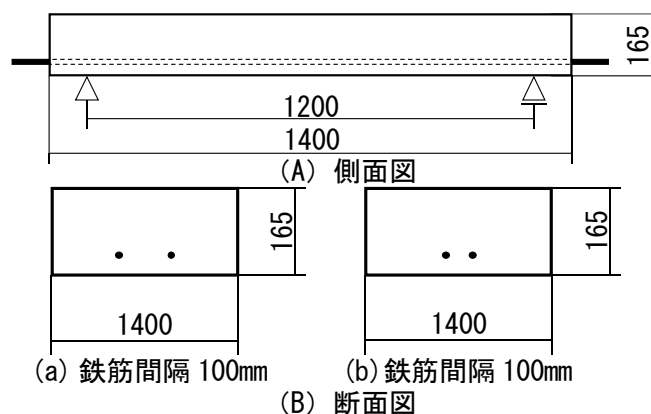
RC 梁試験体の寸法および配筋図（単位：mm）
